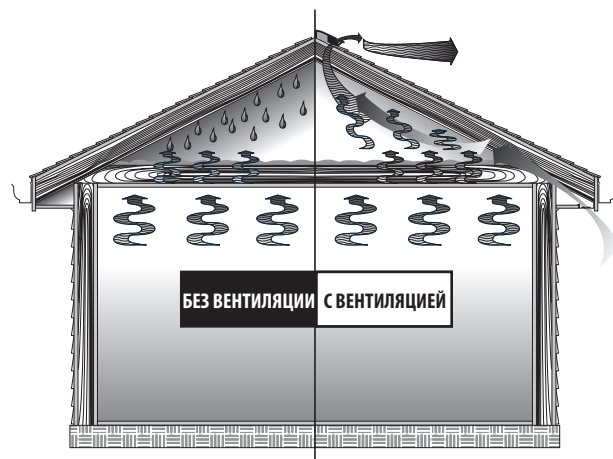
Без вентиляции: Влага, поднимаясь из дома, конденсируется в чердачном помещении, вызывая разрушение стоек каркаса крыши, изоляции и других материалов. С вентиляцией: Вентиляция чердачного помещения обеспечивает отвод влаги.
